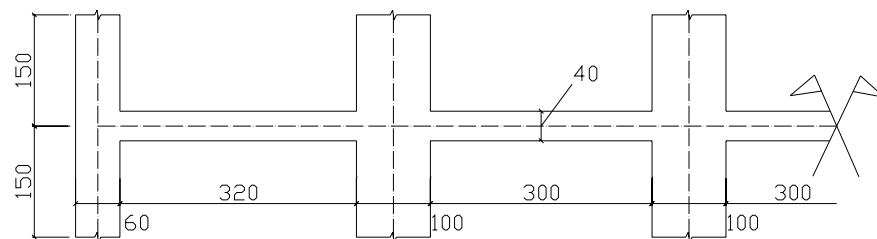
Geometria da viga, Caso 6 (dimensões em cm)
